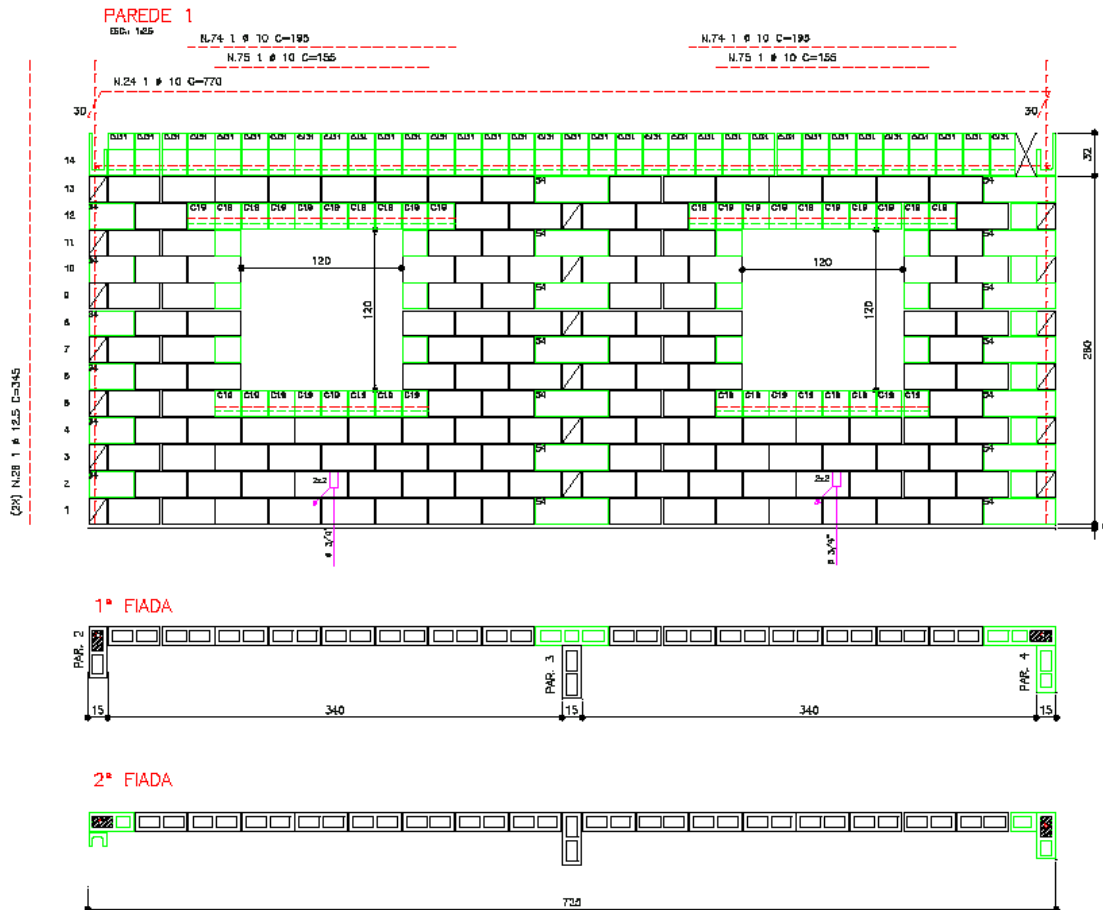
exemplo da elevação (ou paginação) da parede 1 de uma edificação de alvenaria estrutural
